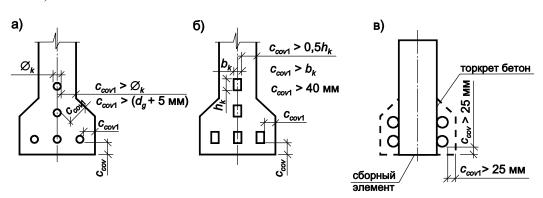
Расположение напрягаемых элементов в сечении при натяжении на бетон (пост-натяжение)
